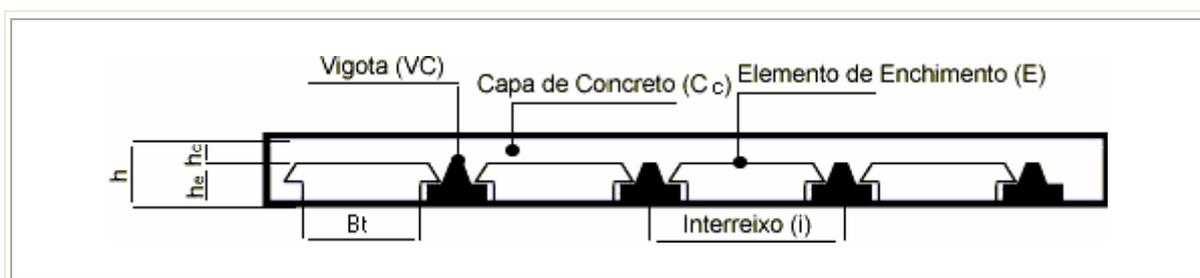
Laje com vigotas de concreto armado (VC). (Adaptada)
